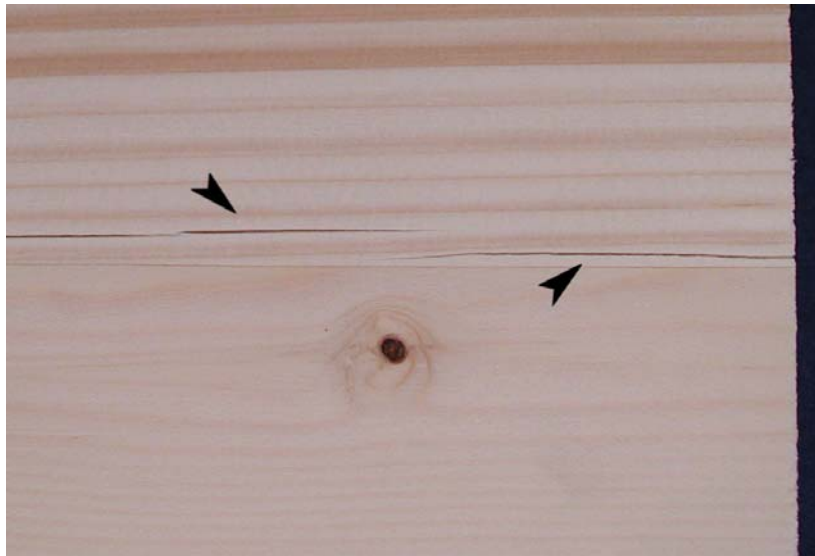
Riss in tangentialer Richtung nahe einer Lamellenverbindung. Obere Lamelle: Stehende Jahrringe; untere Lamelle: Liegende Jahrringe.
